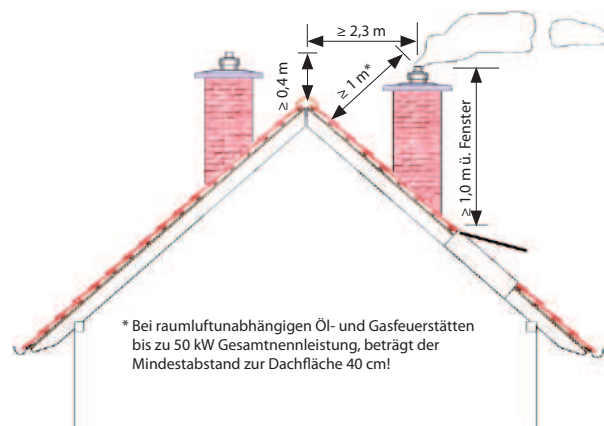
, Mindesthöhen der Abgasanlagen über Dach, Dachneigungen ≥ 20°
